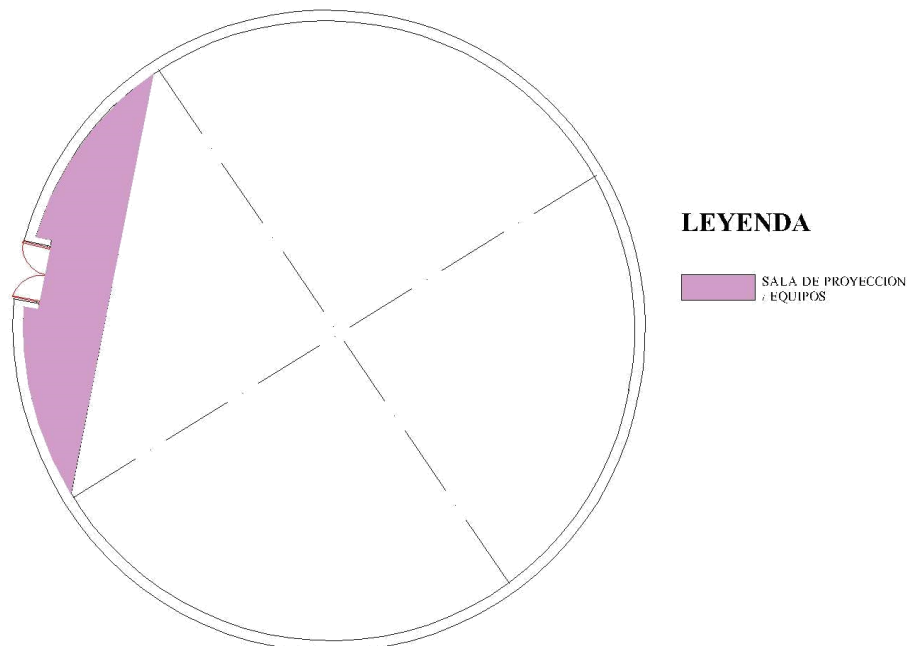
Zonificación Primera Planta Alta Salón de Actos-Fuente: Elaboración Propia
